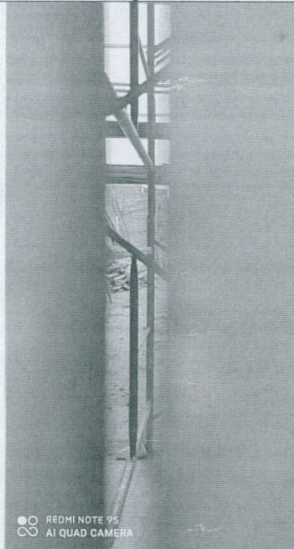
Se observa fachada sobre la carrera 80 H, en donde se observa modificación en la cubierta con instalación de estructura metálica.
